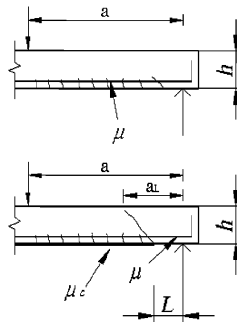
Концепция потери сцепления материала усиления с железобетонной конструкцией от действия сдвиговых усилий: μ_c – коэффициент армирования конструкции композитным материалом; μ – коэффициент армирования конструкции стальной арматурой; h – высота сечения конструкции; L – расстояние от опоры до ленты композитного материала; a_L – расстояние от опоры до верхней границы крайней к опоре наклонной трещины; a – расстояние от точки приложения силы до опоры.
